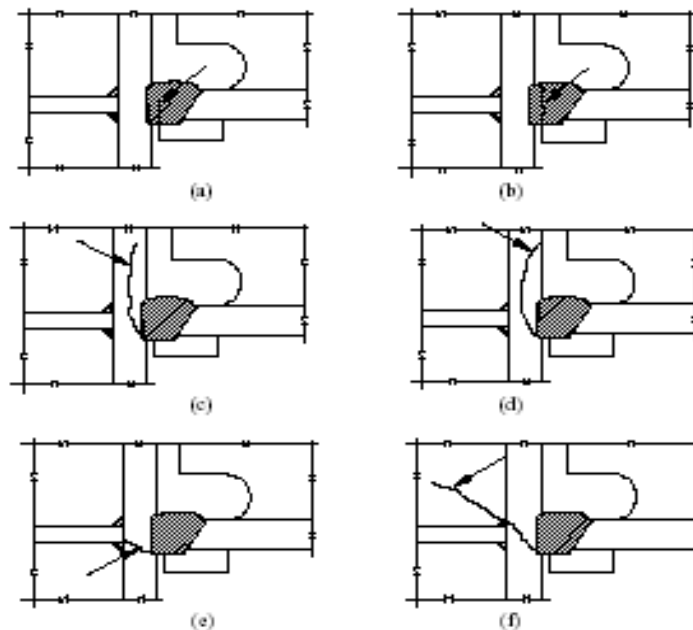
Tipos de fallas que se presentan en una conexión viga-columna de acero. Fuente EERC.
